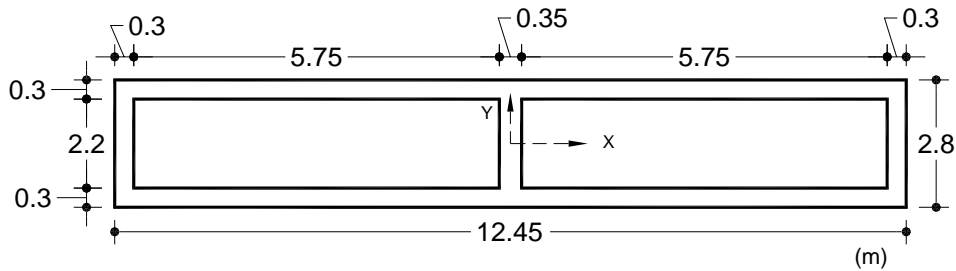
Sección 3 de la columna 13. (No. 13)
